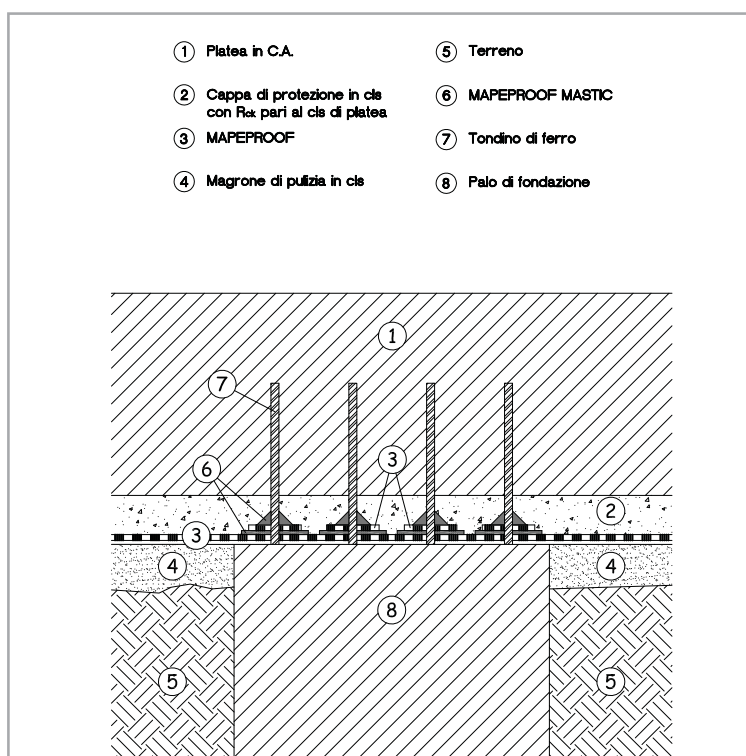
Particolare tecnico dell'impermeabilizzazione della testa del palo collaborante con la platea e non passante il telo bentonitico
